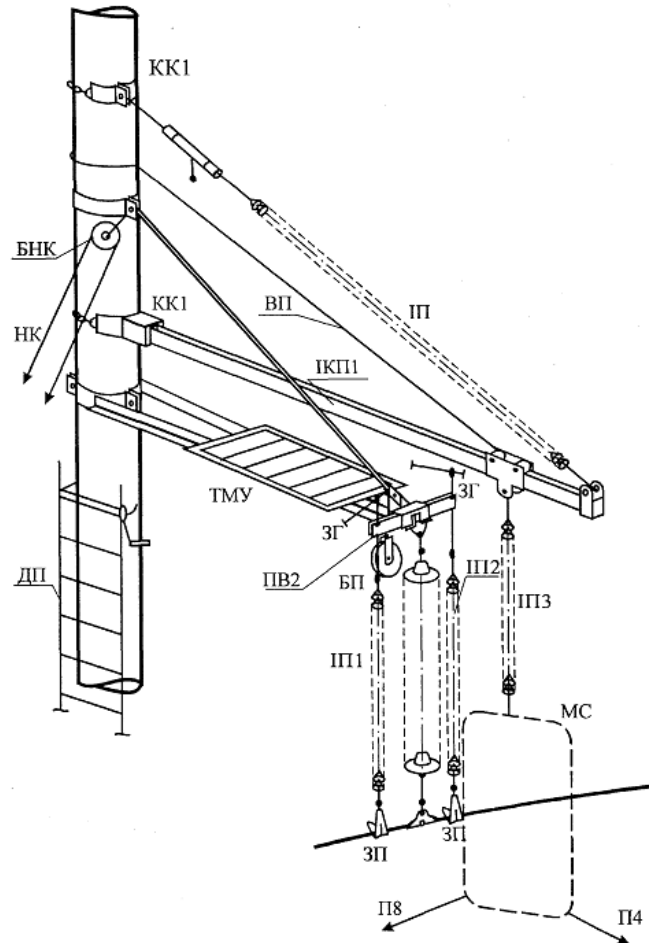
Схема доставляння електромонтера до проводу ПЛ 110 кВ на залізобетонних опорах за допомогою відкотної балки
